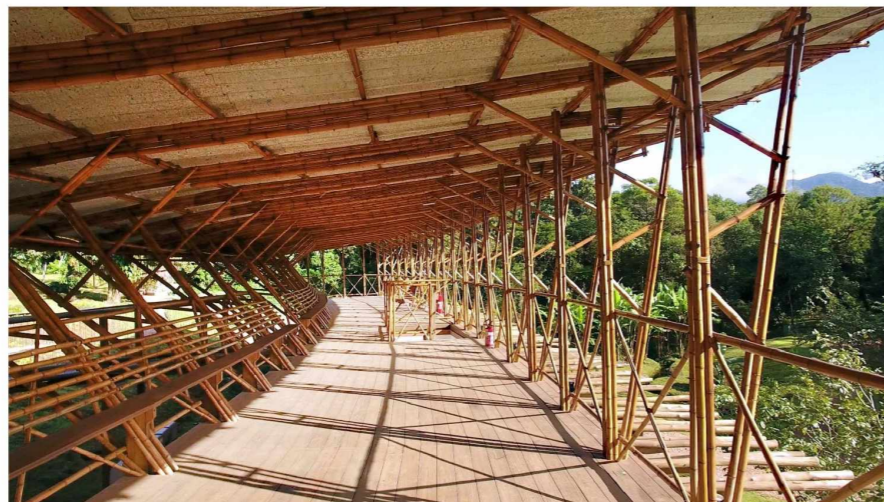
Segundo pavimento do Pavilhão de Oficinas. Fonte: ArchDaily
